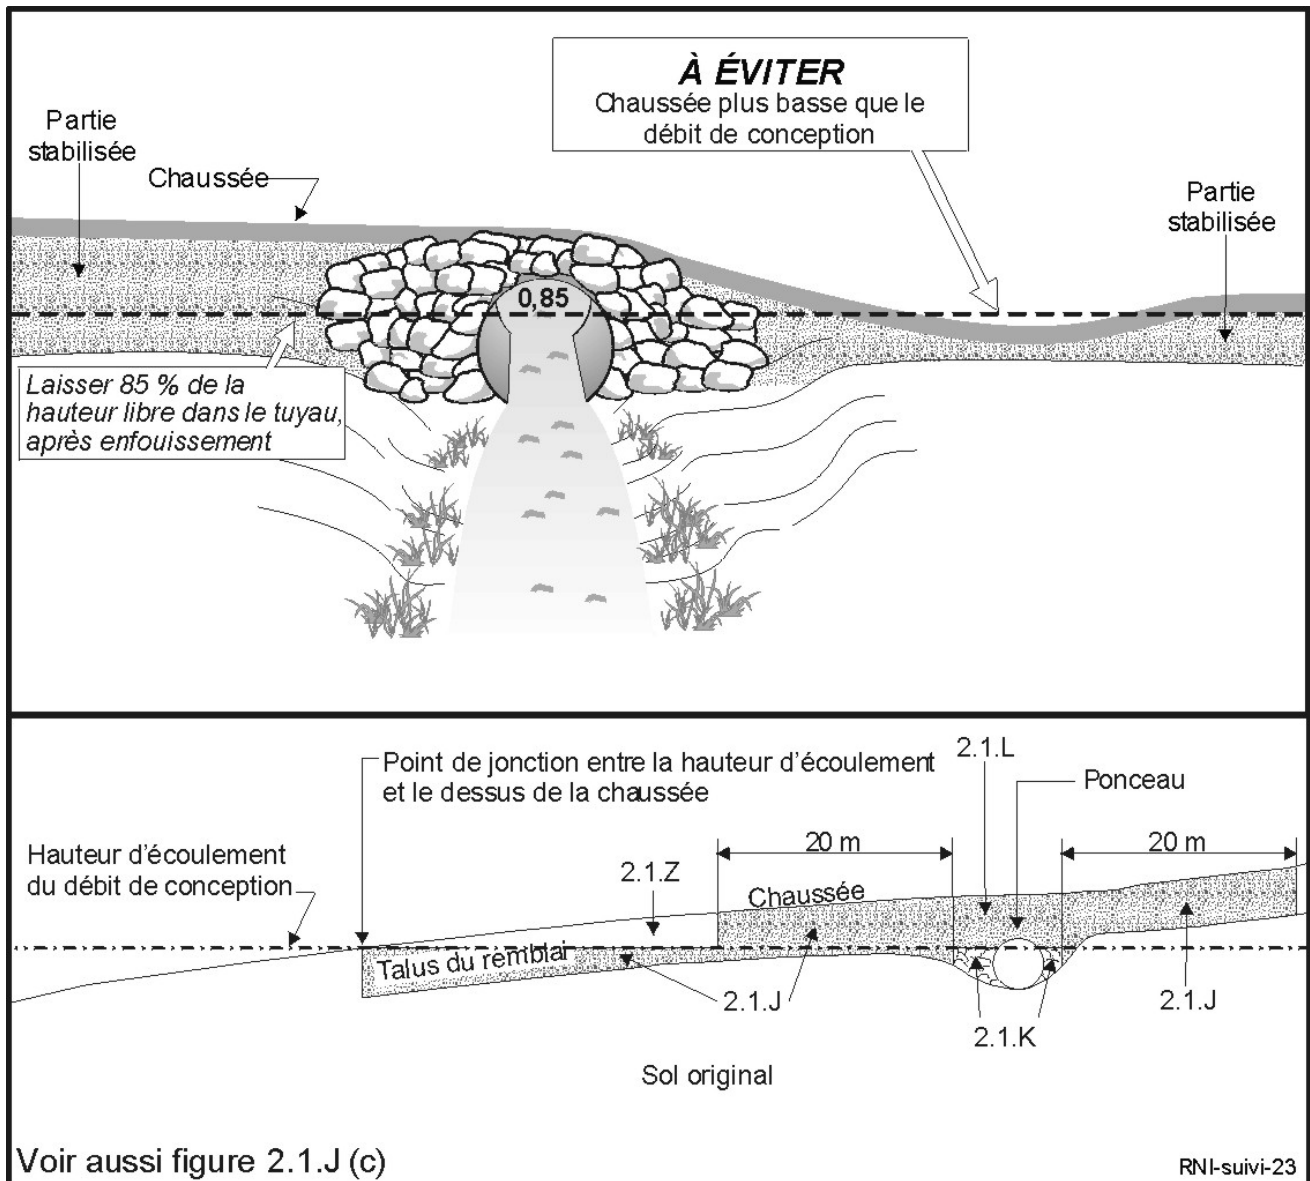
Z. Hauteur de la chaussée par rapport à la hauteur du débit de conception
